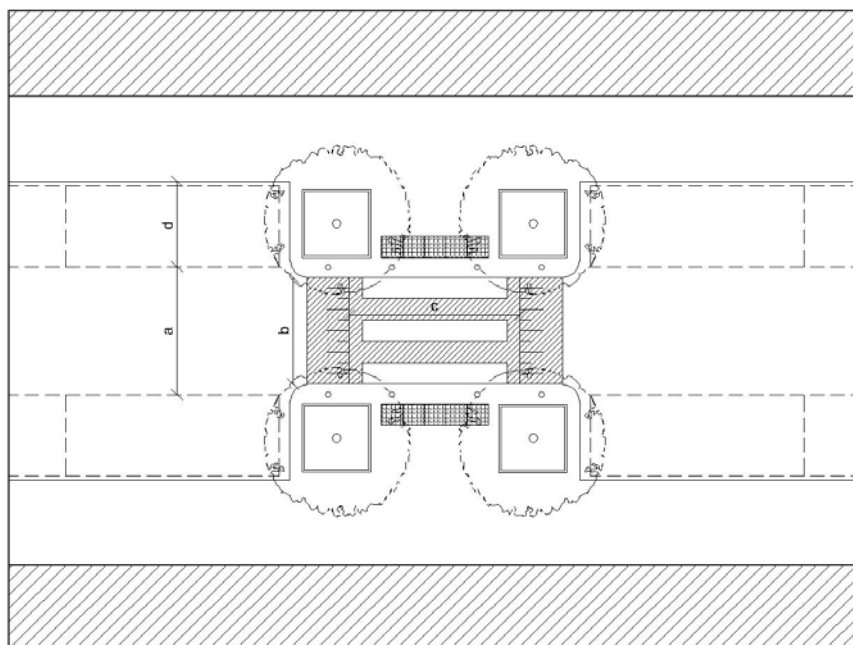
Schema di un attraversamento pedonale rialzato con la pavimentazione tattile per gli ipovedenti
